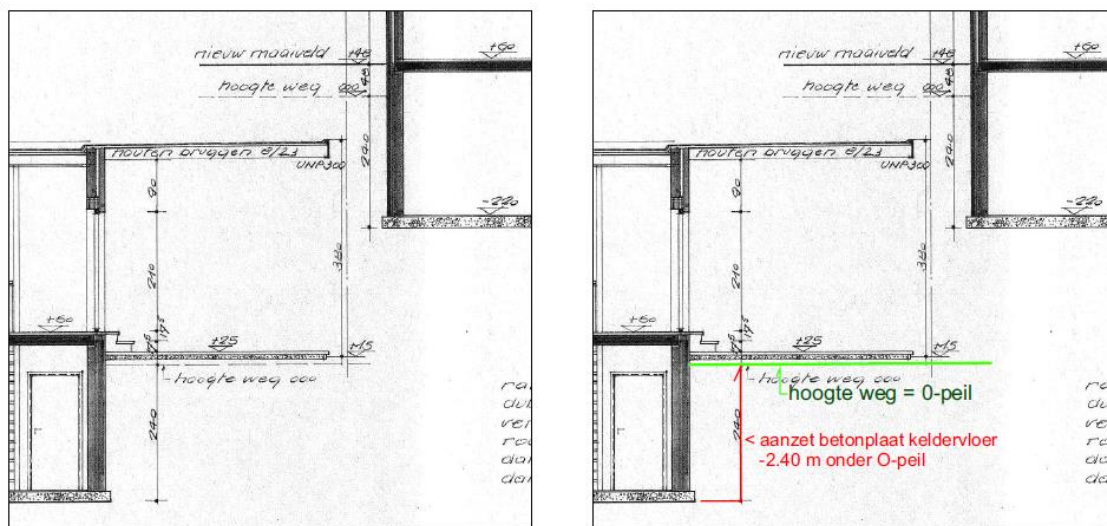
detail uit doorsnede c-d © ATRIUM architecten
